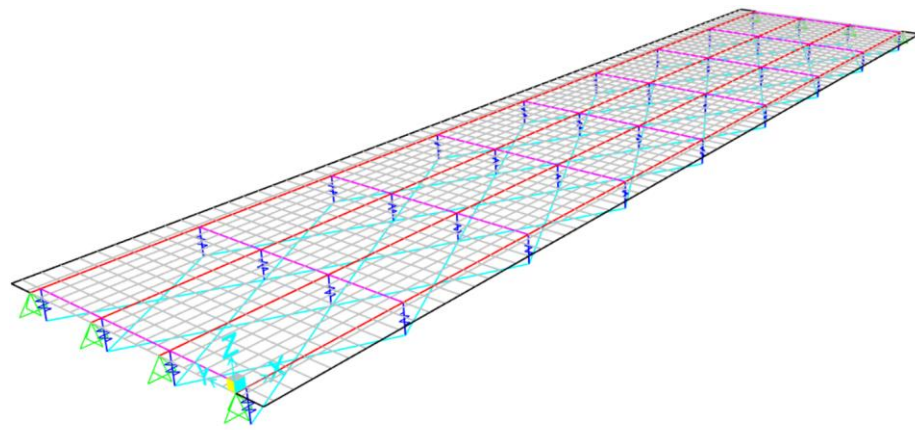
Vista 3D tipo standard del modelo. Elaboración propia con SAP2000.
